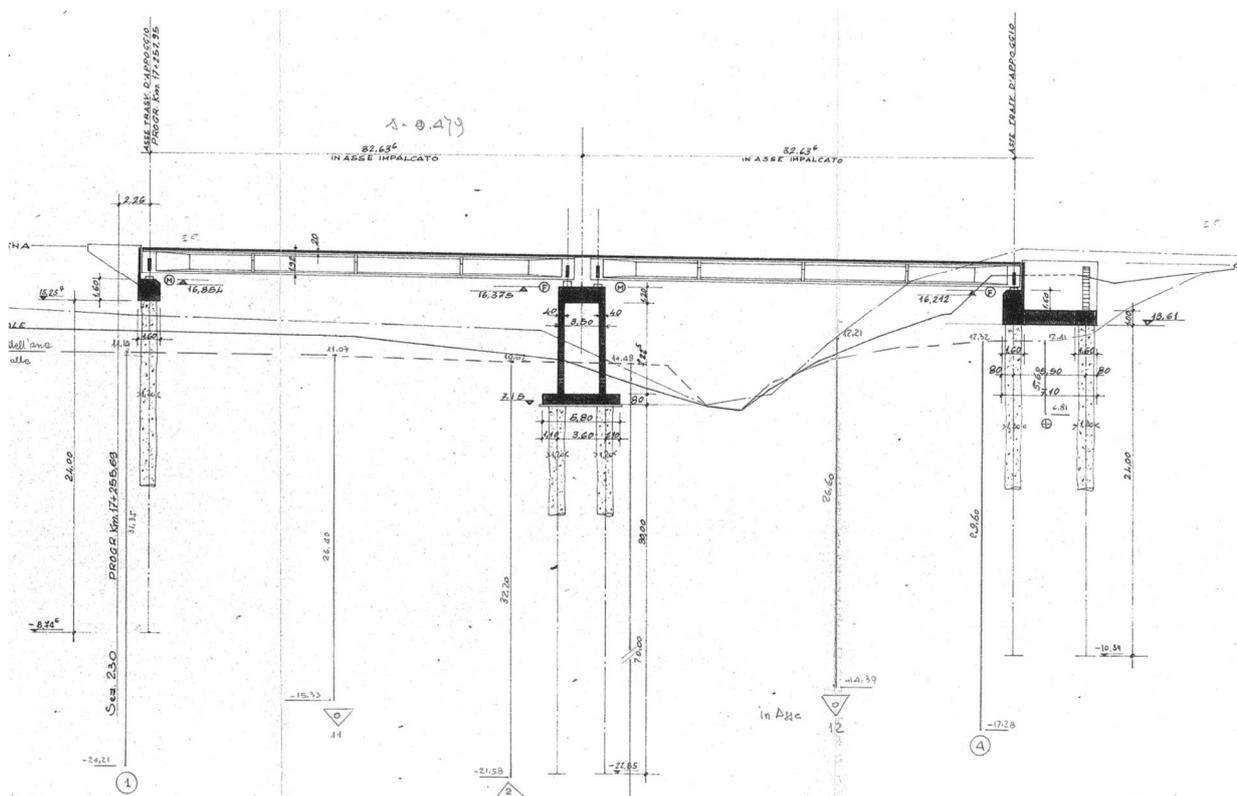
Viadotto Cacchione – Profilo longitudinale di Carreggiata Nord (dalla Contabilità lavori) (Doc.Ref.[7])
